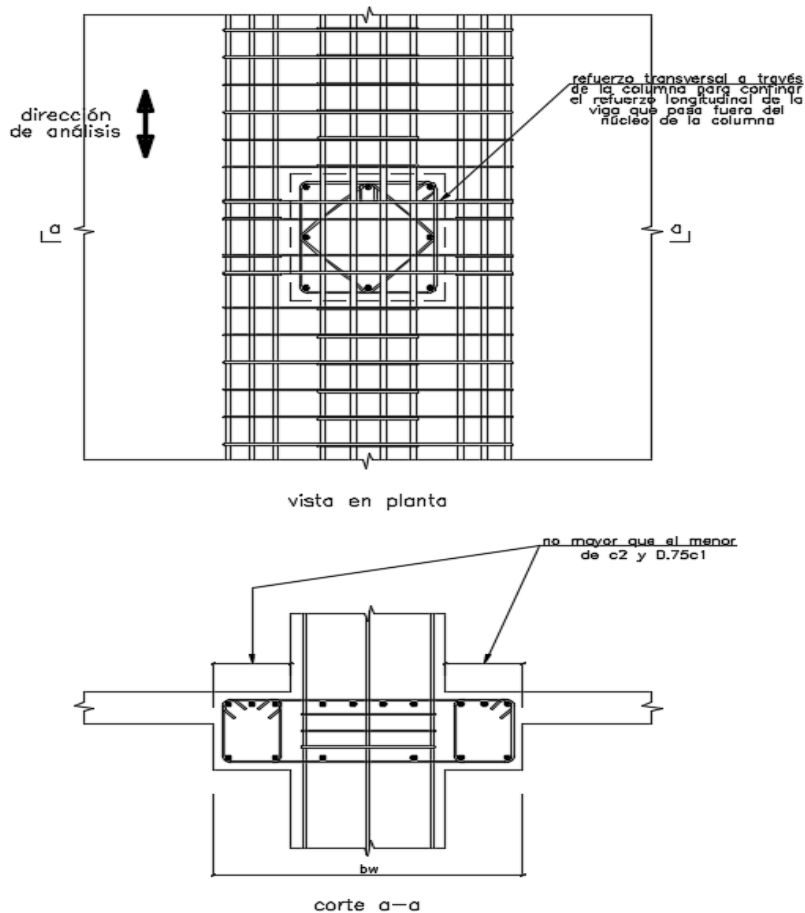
Máximo ancho efectivo de una viga ancha
